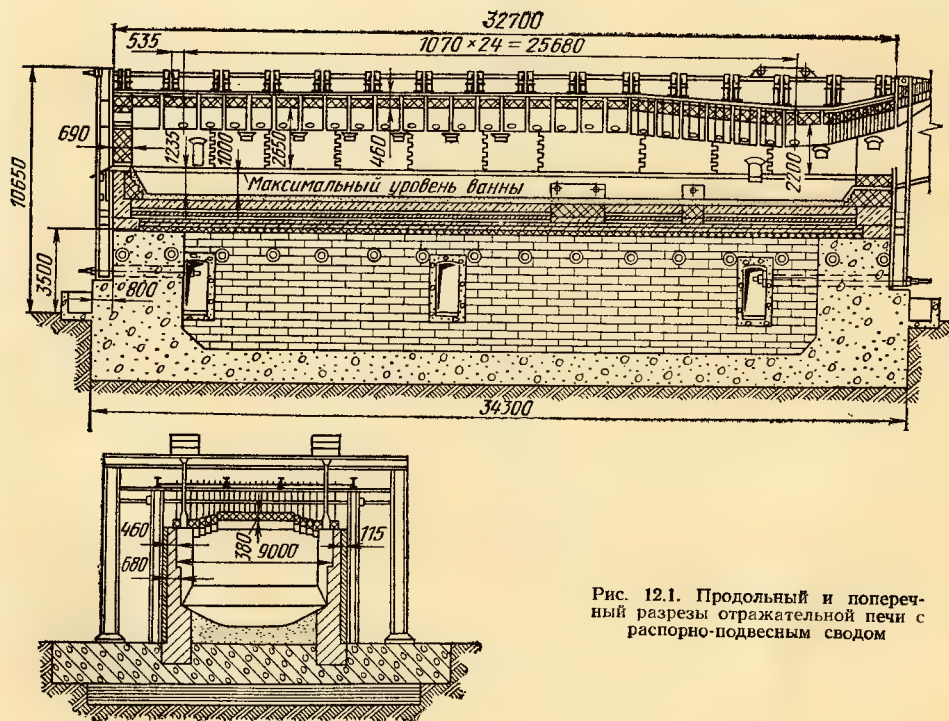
Продольный и поперечный разрезы отражательной печи с распорно-подвесным сводом
